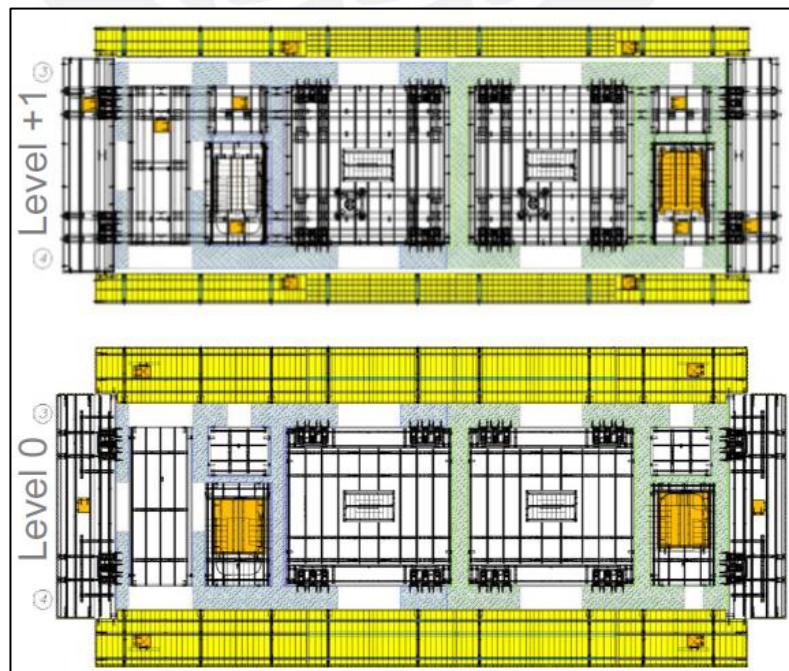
22 Vista en planta de Sistema SKE 50 nivel 0 y nivel +1 (DOKA, 2016)
